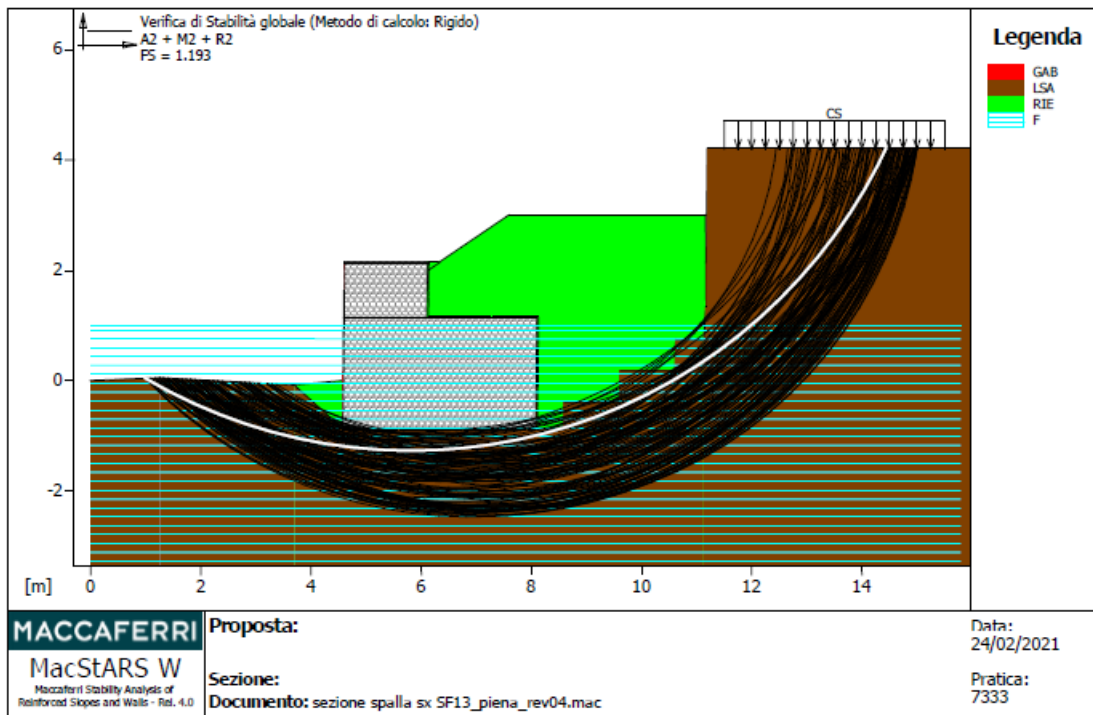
Verifica di stabilità globale sezione spalla sx- condizione di piena -statica
